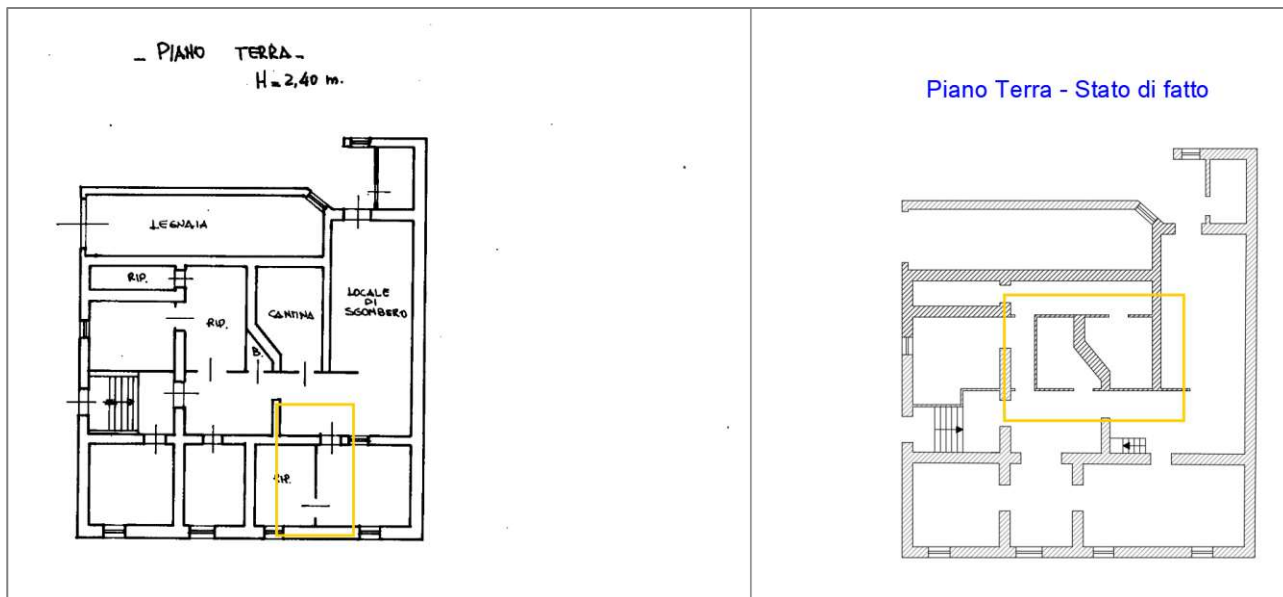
Confronto tra planimetria catastale e stato di fatto: Piano Terra
